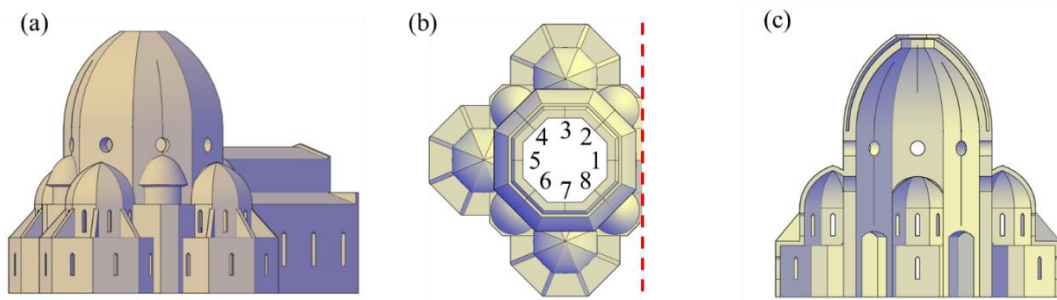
(a) Vista isométrica do modelo tridimensional da estrutura contendo as fissuras verticais (b) Corte superior para vista das fissuras verticais nas superfícies do octógono da Cúpula (c) Corte transversal para vista das fissuras verticais na parte interna da estrutura.
